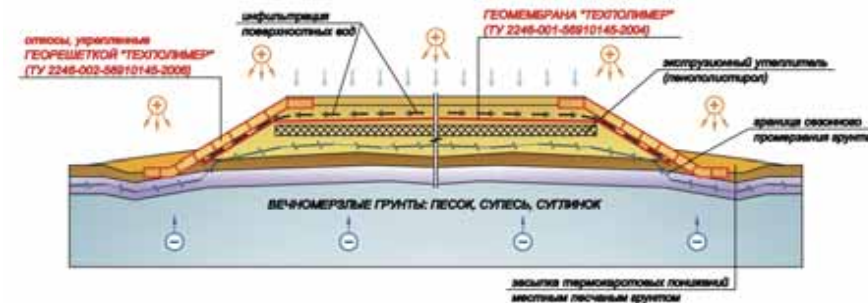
Строительство на вечномерзлых грунтах. Гидроизоляция основания из геомембраны
